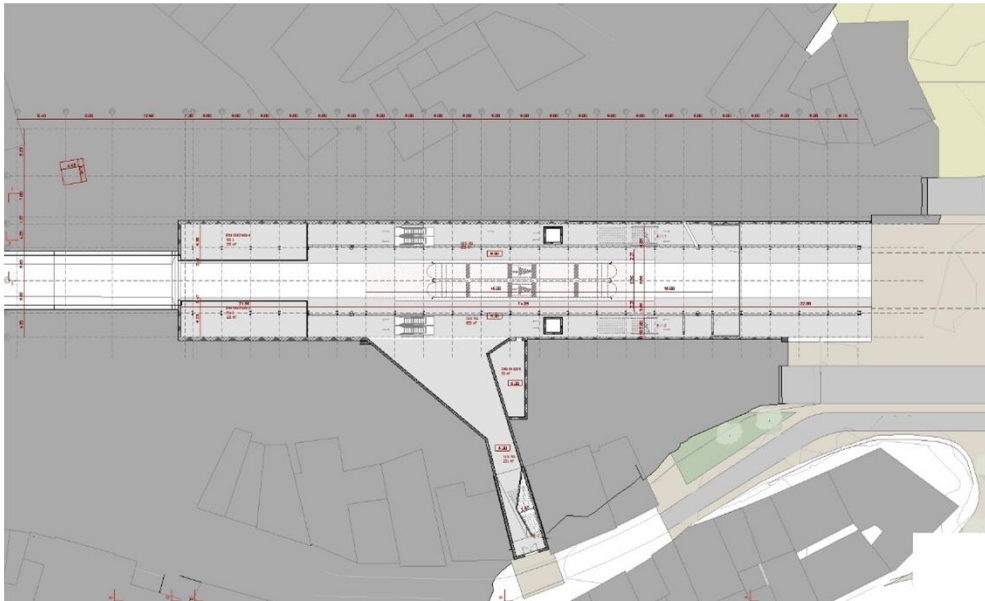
Planta Piso -1 – Cais Lios (ML 134353).
